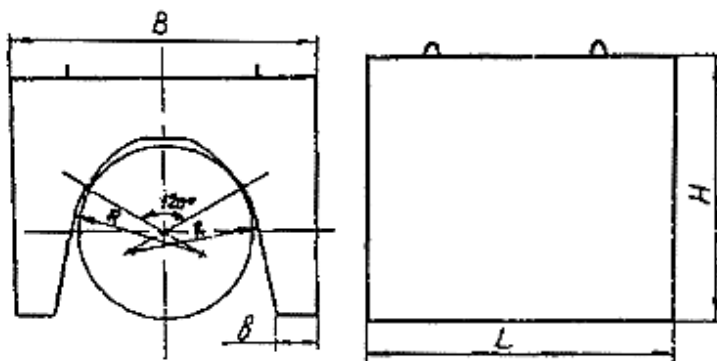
Железобетонный утяжелитель типа 1-УБКМ
